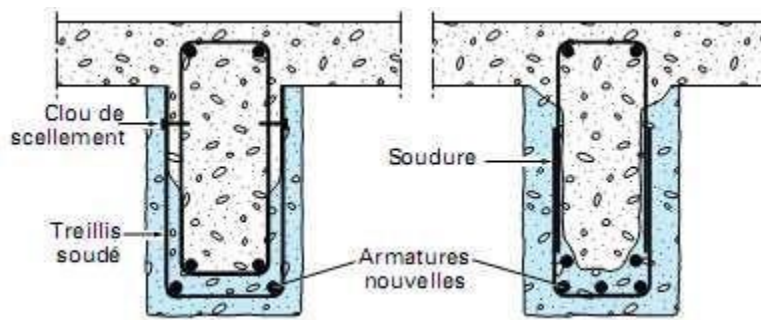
Armatures supplémentaires en surépaisseur de poutre
